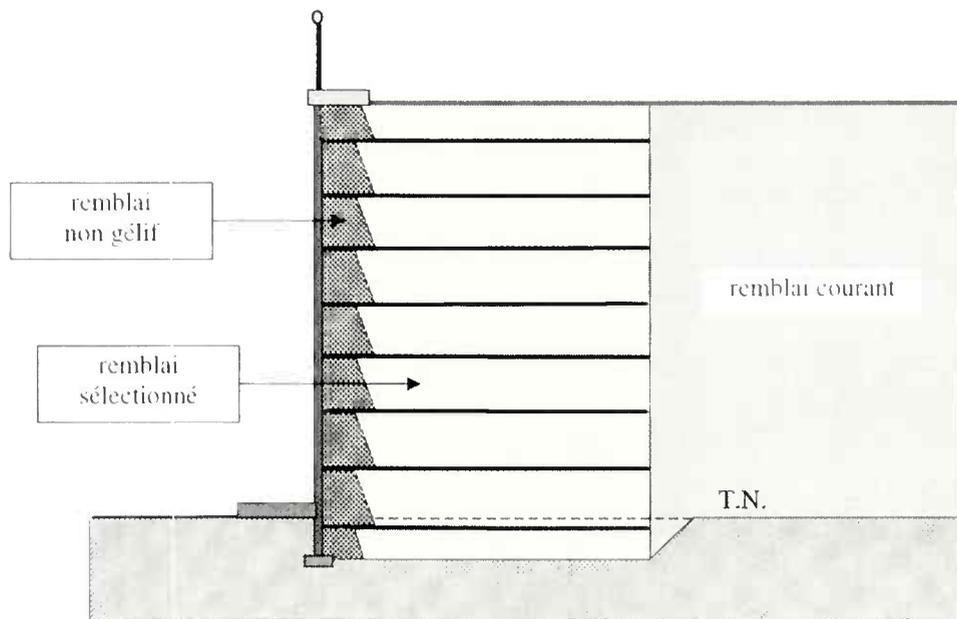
Protection contre le gel d'un massif en remblai renforcé
